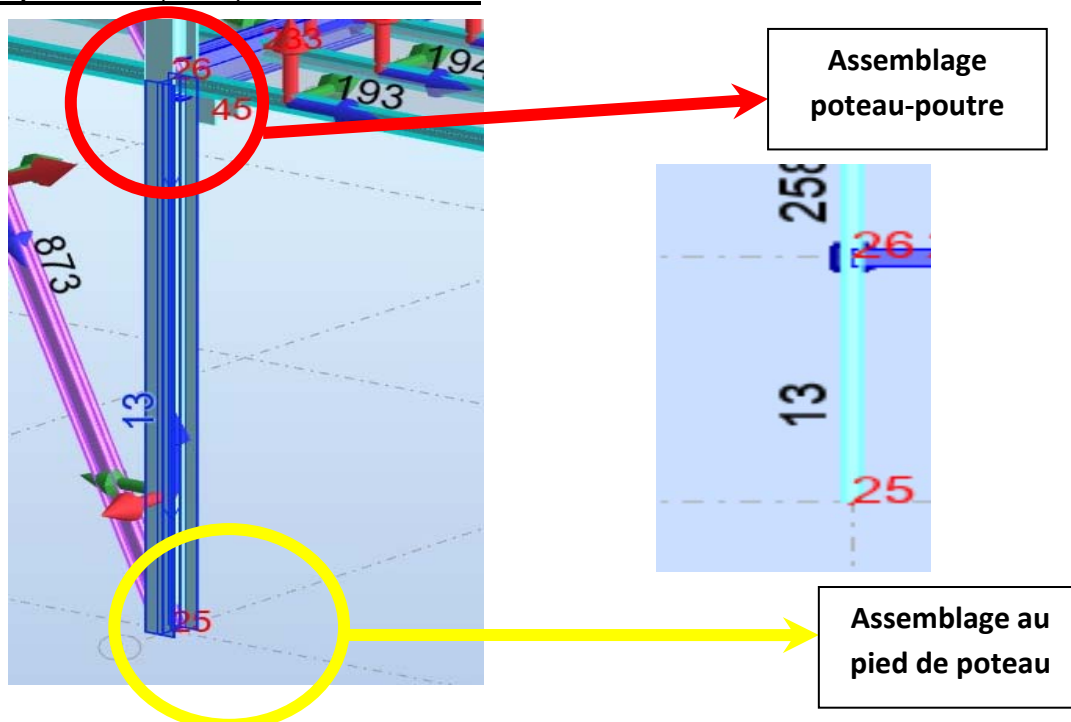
modèle d'un assemblage poteau-poutre et pied de poteau
